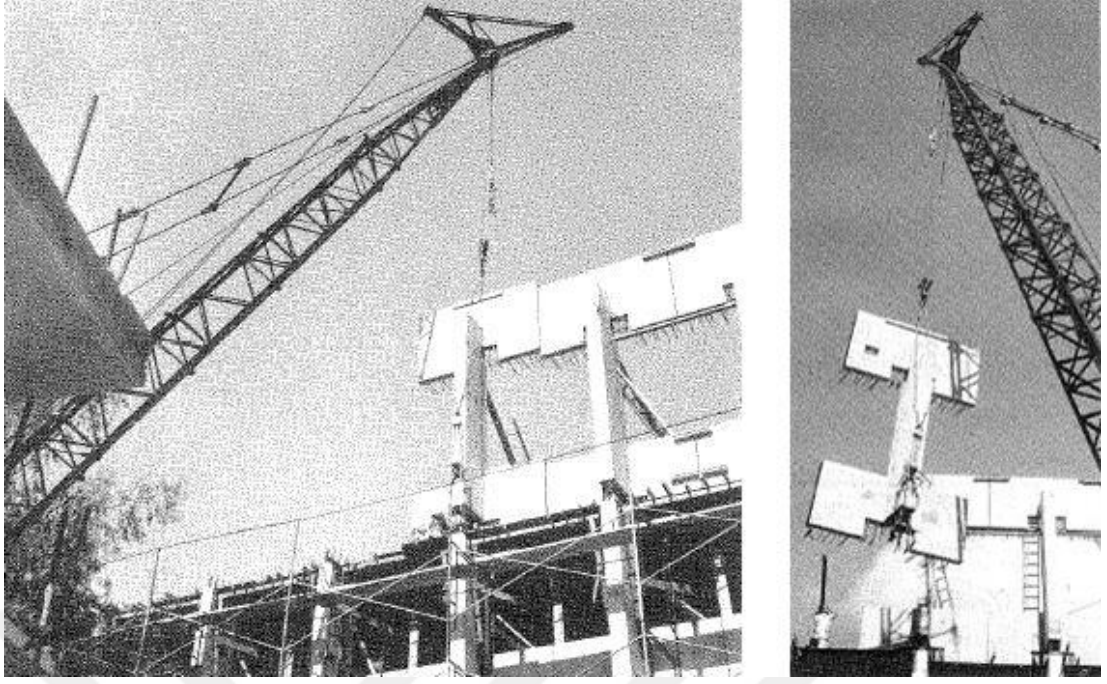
UC Berkeley Wurster Hall (UC Berkeley Wurster Hall, 2018)
